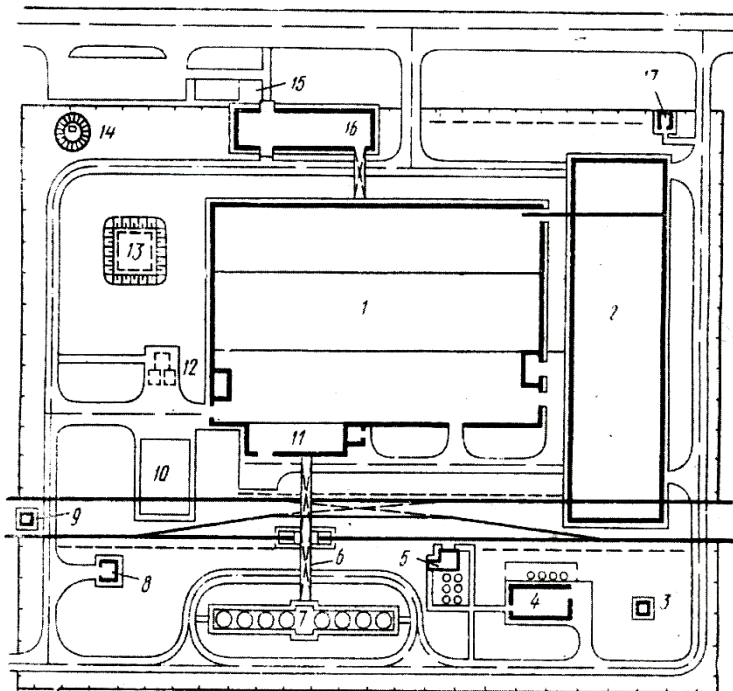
Генплан заводу залізобетонних конструкцій для водогосподарського будівництва:
